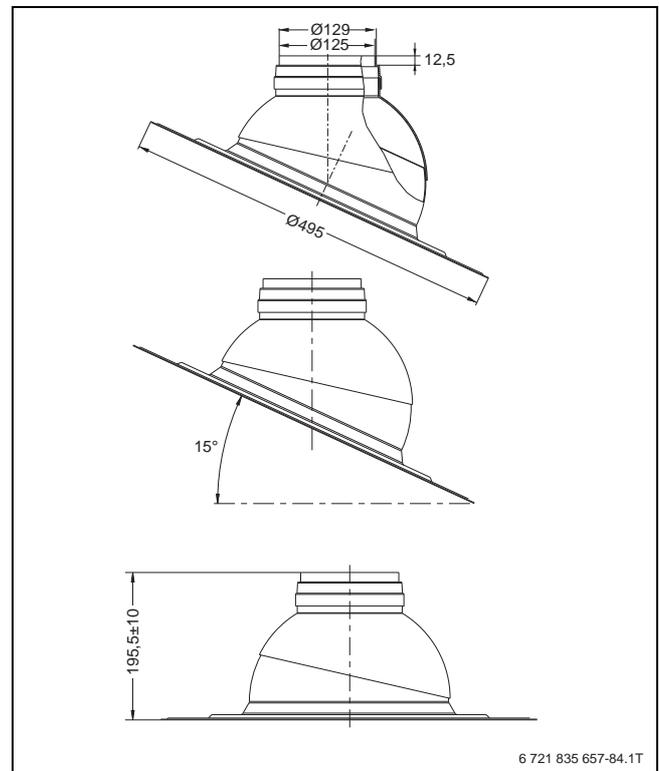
Flachdach-Klebeflansch (Maße in mm)
